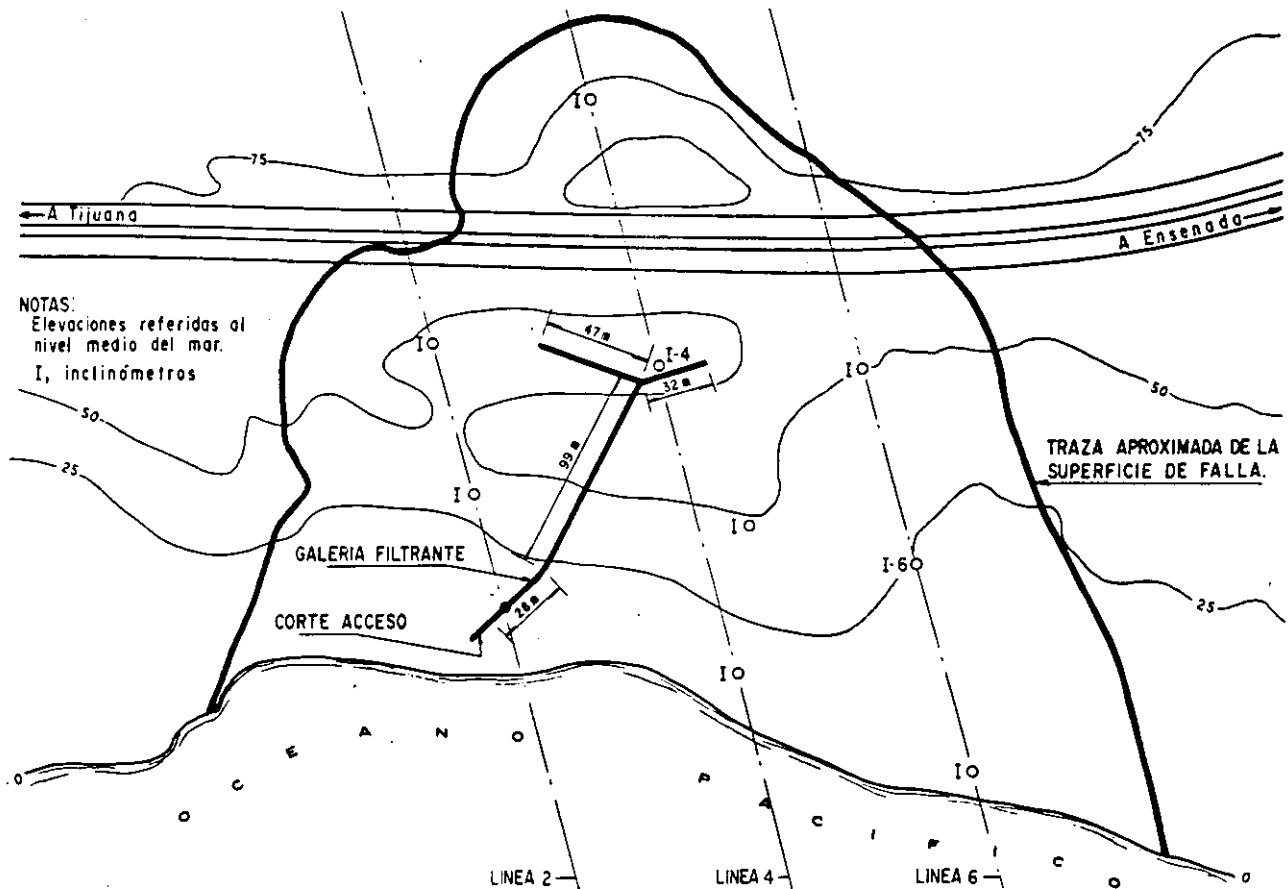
Planta de la galería filtrante del km 15 + 500 de la autopista Tijuana-Ensenada (Ref. 30).
